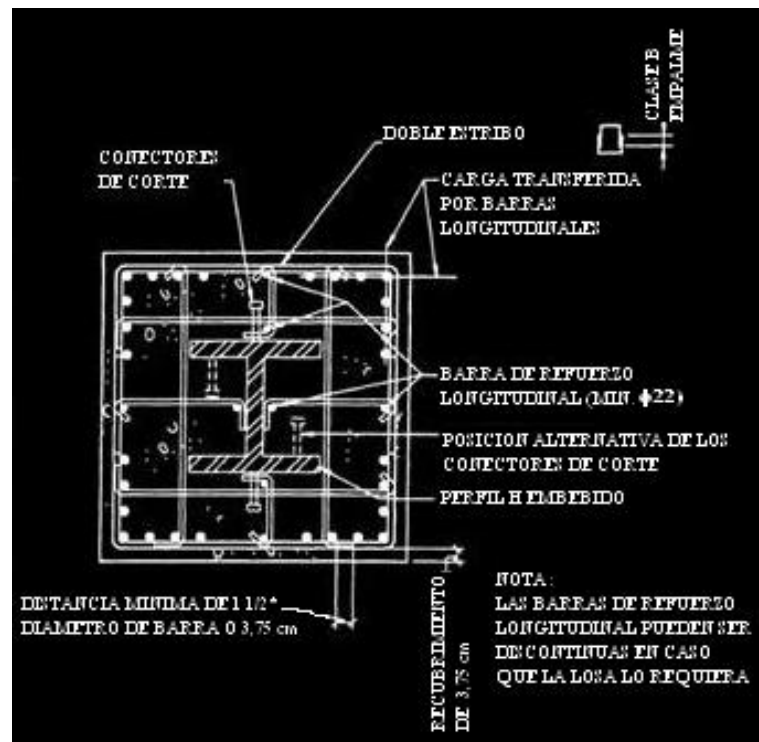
Sección Transversal de una columna compuesta SRC [3]
